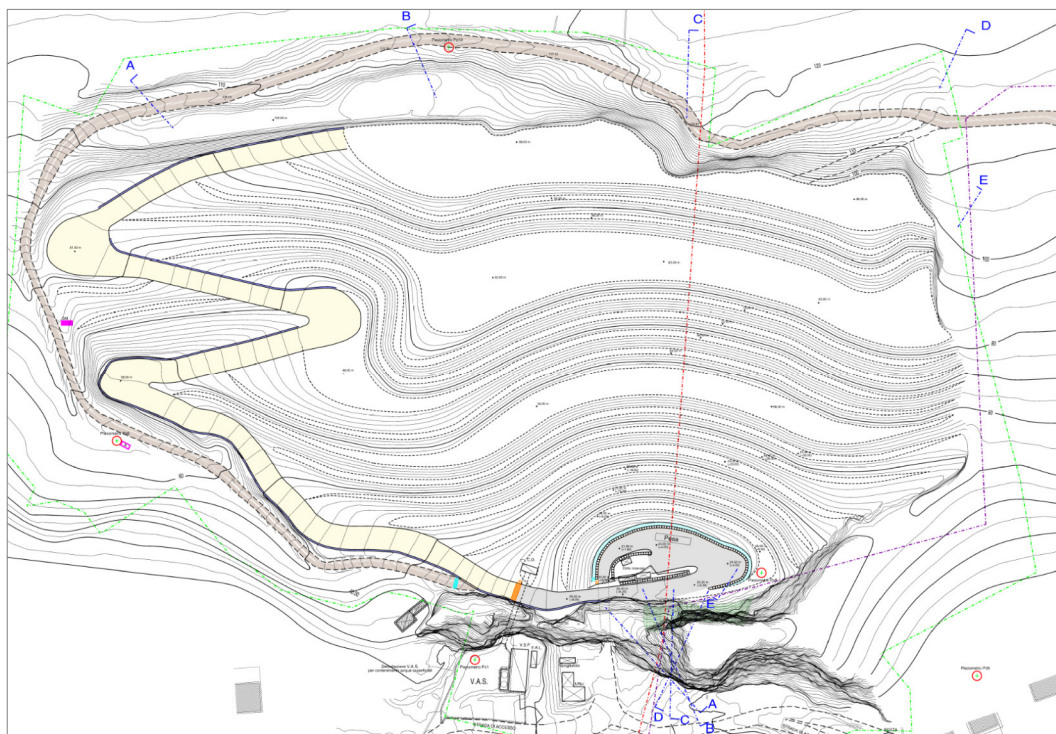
Estratto planimetria dello stato di progetto al termine dei conferimenti (termine Fase 3)
